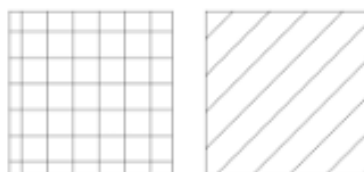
Marcação de pavimentos e coberturas, respetivamente
